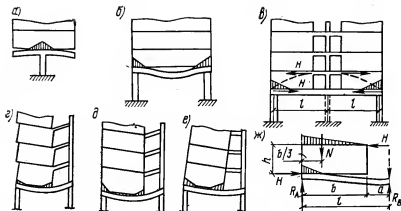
Схемы передачи нагрузки от панельных стен на поддерживающие ригели
